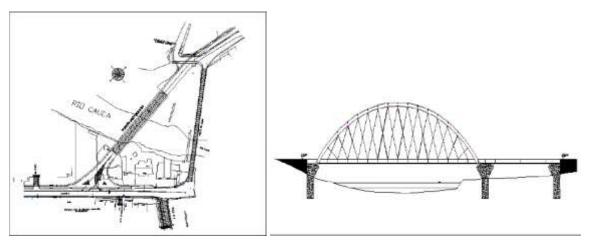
DIBUJO EN PLANTA Y PERFIL
